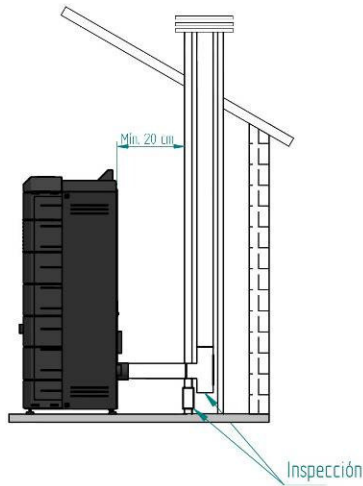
Vista lateral de la instalación con chimenea, con ejemplo del punto de inspección.
